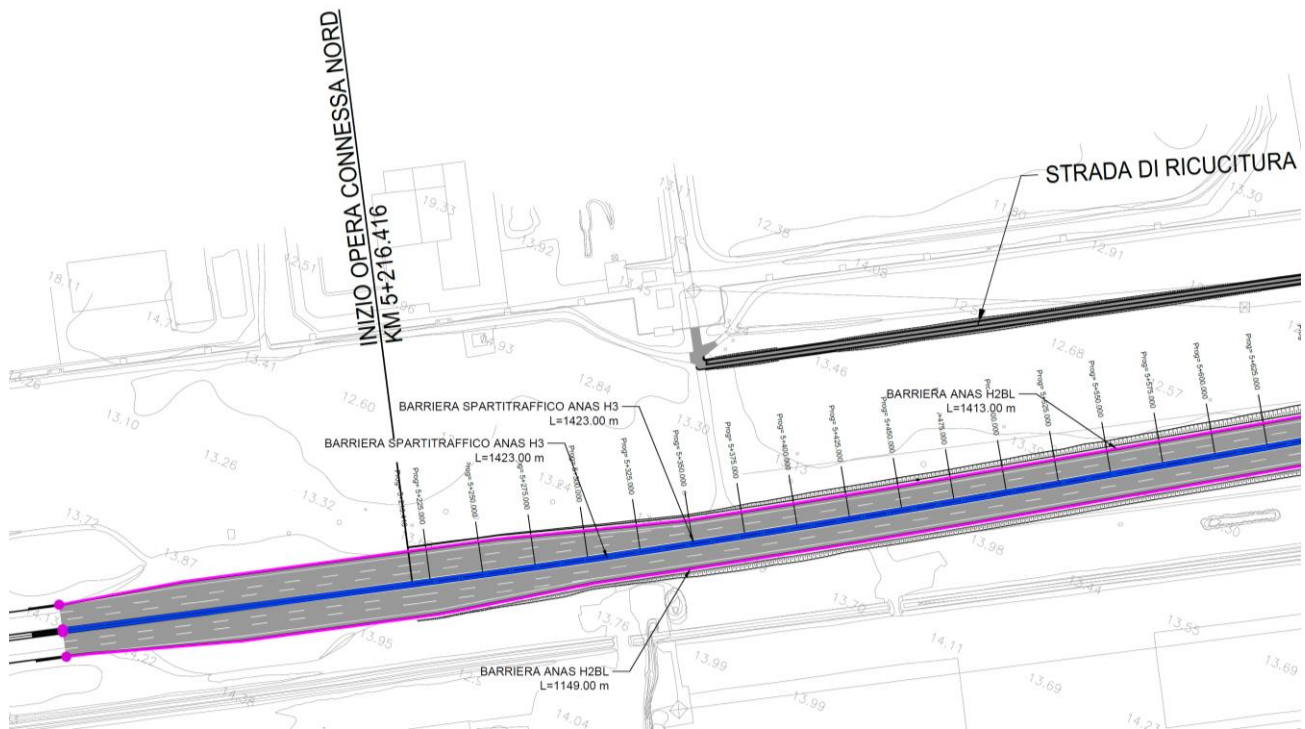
Stralcio Planimetria d'insieme Opera Connessa Nord
